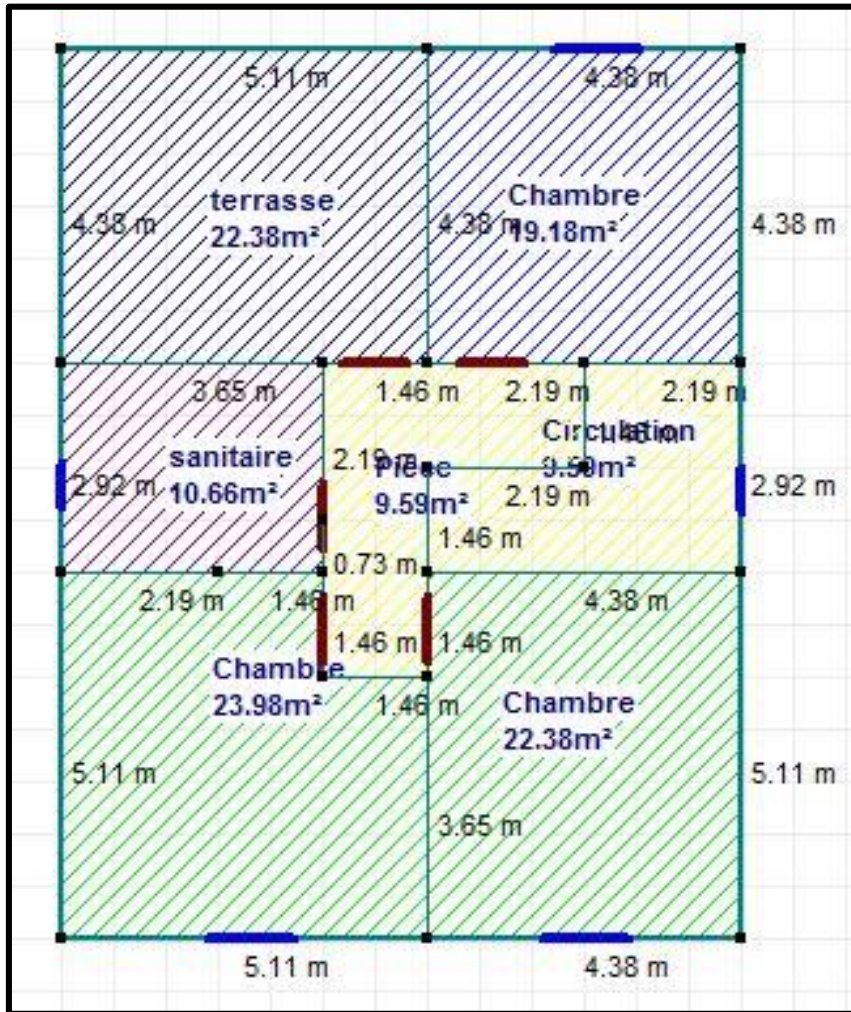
Le plan de 1^{er} étage sur ALCYONE
